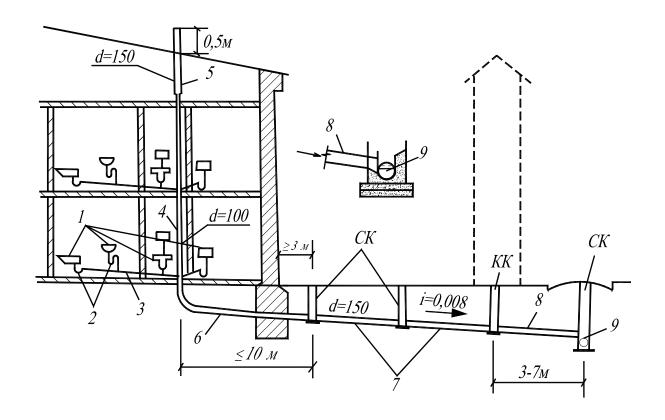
Схема внутренней водоотводящей системы жилого дома: 1 – санитарные приборы; 2 – гидравлические затворы; 3 – отводные трубы; 4 – стояк; 5 – вентиляционная (вытяжная) труба; 6 – выпуск
